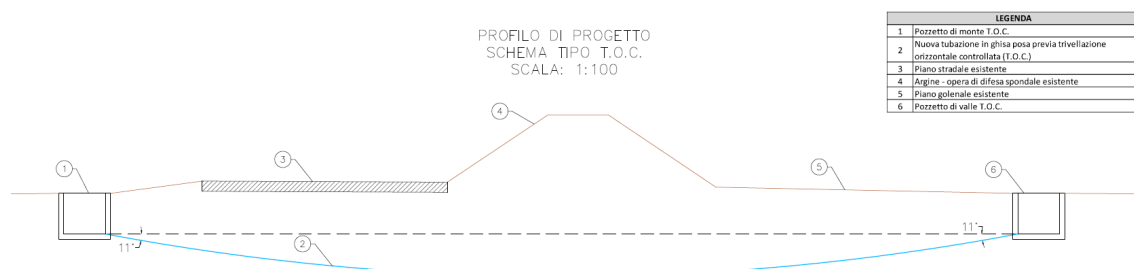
Schema tipo profilo di progetto posa nuova tubazione in ghisa previa trivellazione orizzontale controllata.
